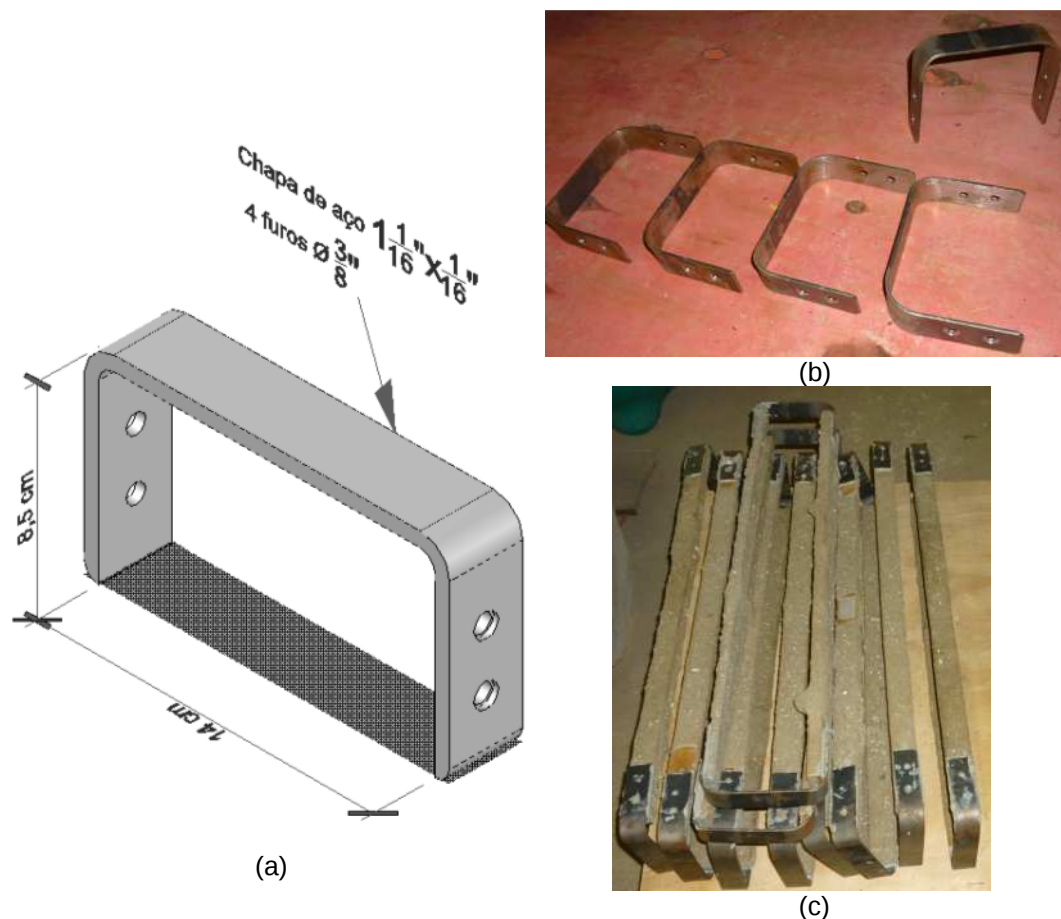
Estribos das vigas V1 e V3. (a) Esquema geral de chapa em aço com forma de C, (b) Chapas em C, (c) Estribos formados por tiras de bambu e chapas de aço.
